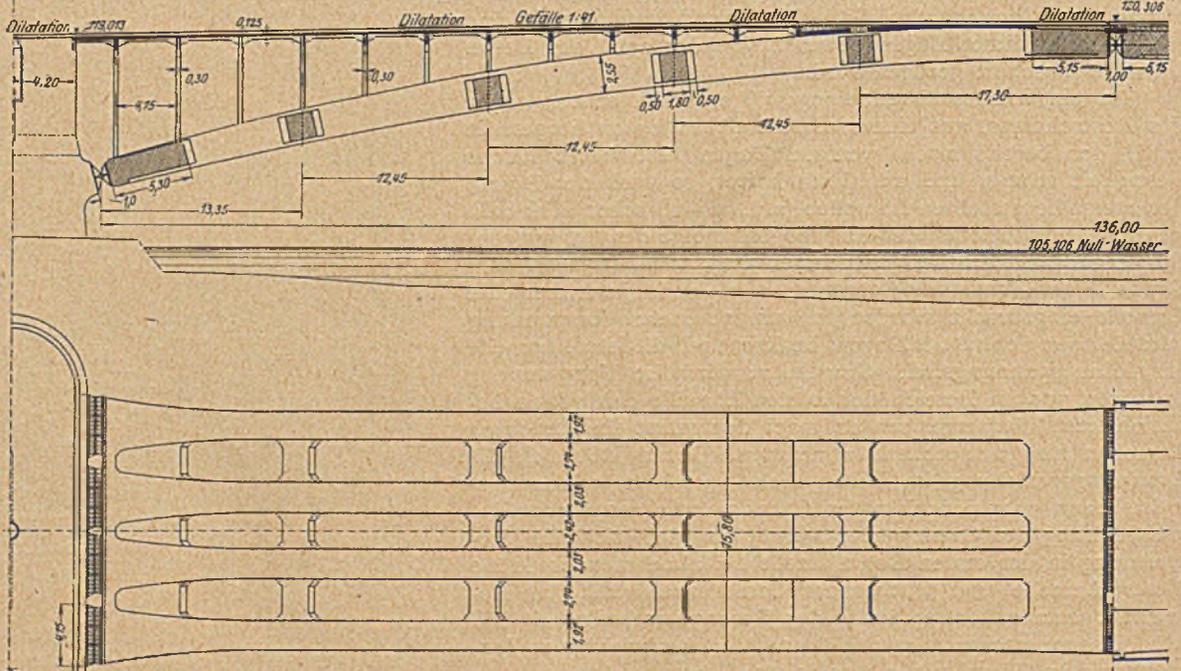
Entwurf Elbbrücke Dresden. Längsschnitt und Grundriß des Hauptbogens von 136 m Spannweite.
